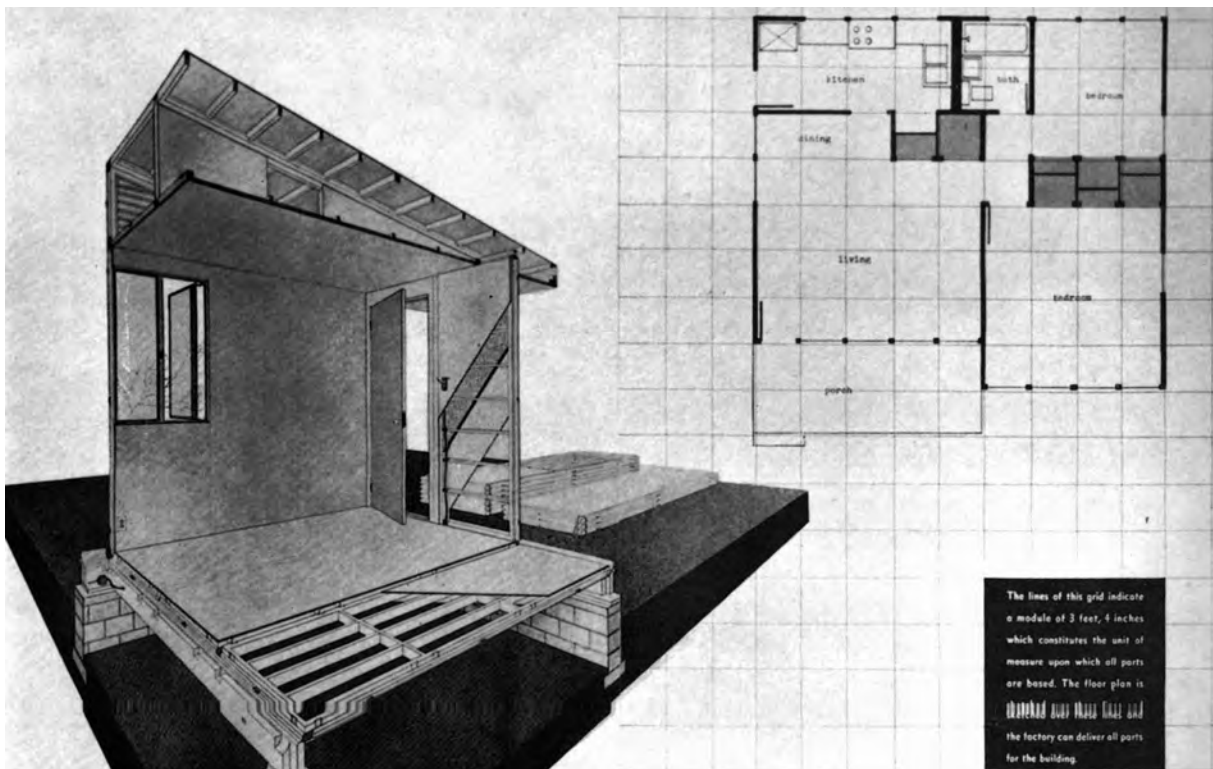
«Bauelemente des General-Panel-Systems: Lagerhölzer, Fussboden-, Wand-, Fenster-, Decken-, Dachplatten und Binder und Giebelfelder nebst den dazugehörigen Füllstäben, und das modulare System (im Raster 3' 4", Anm. d. A.), auf dem sich hier der konventionelle Grundriss des amerikanischen Kleinhauses aufbaut» (Wachsmann 1959, S. 155)
